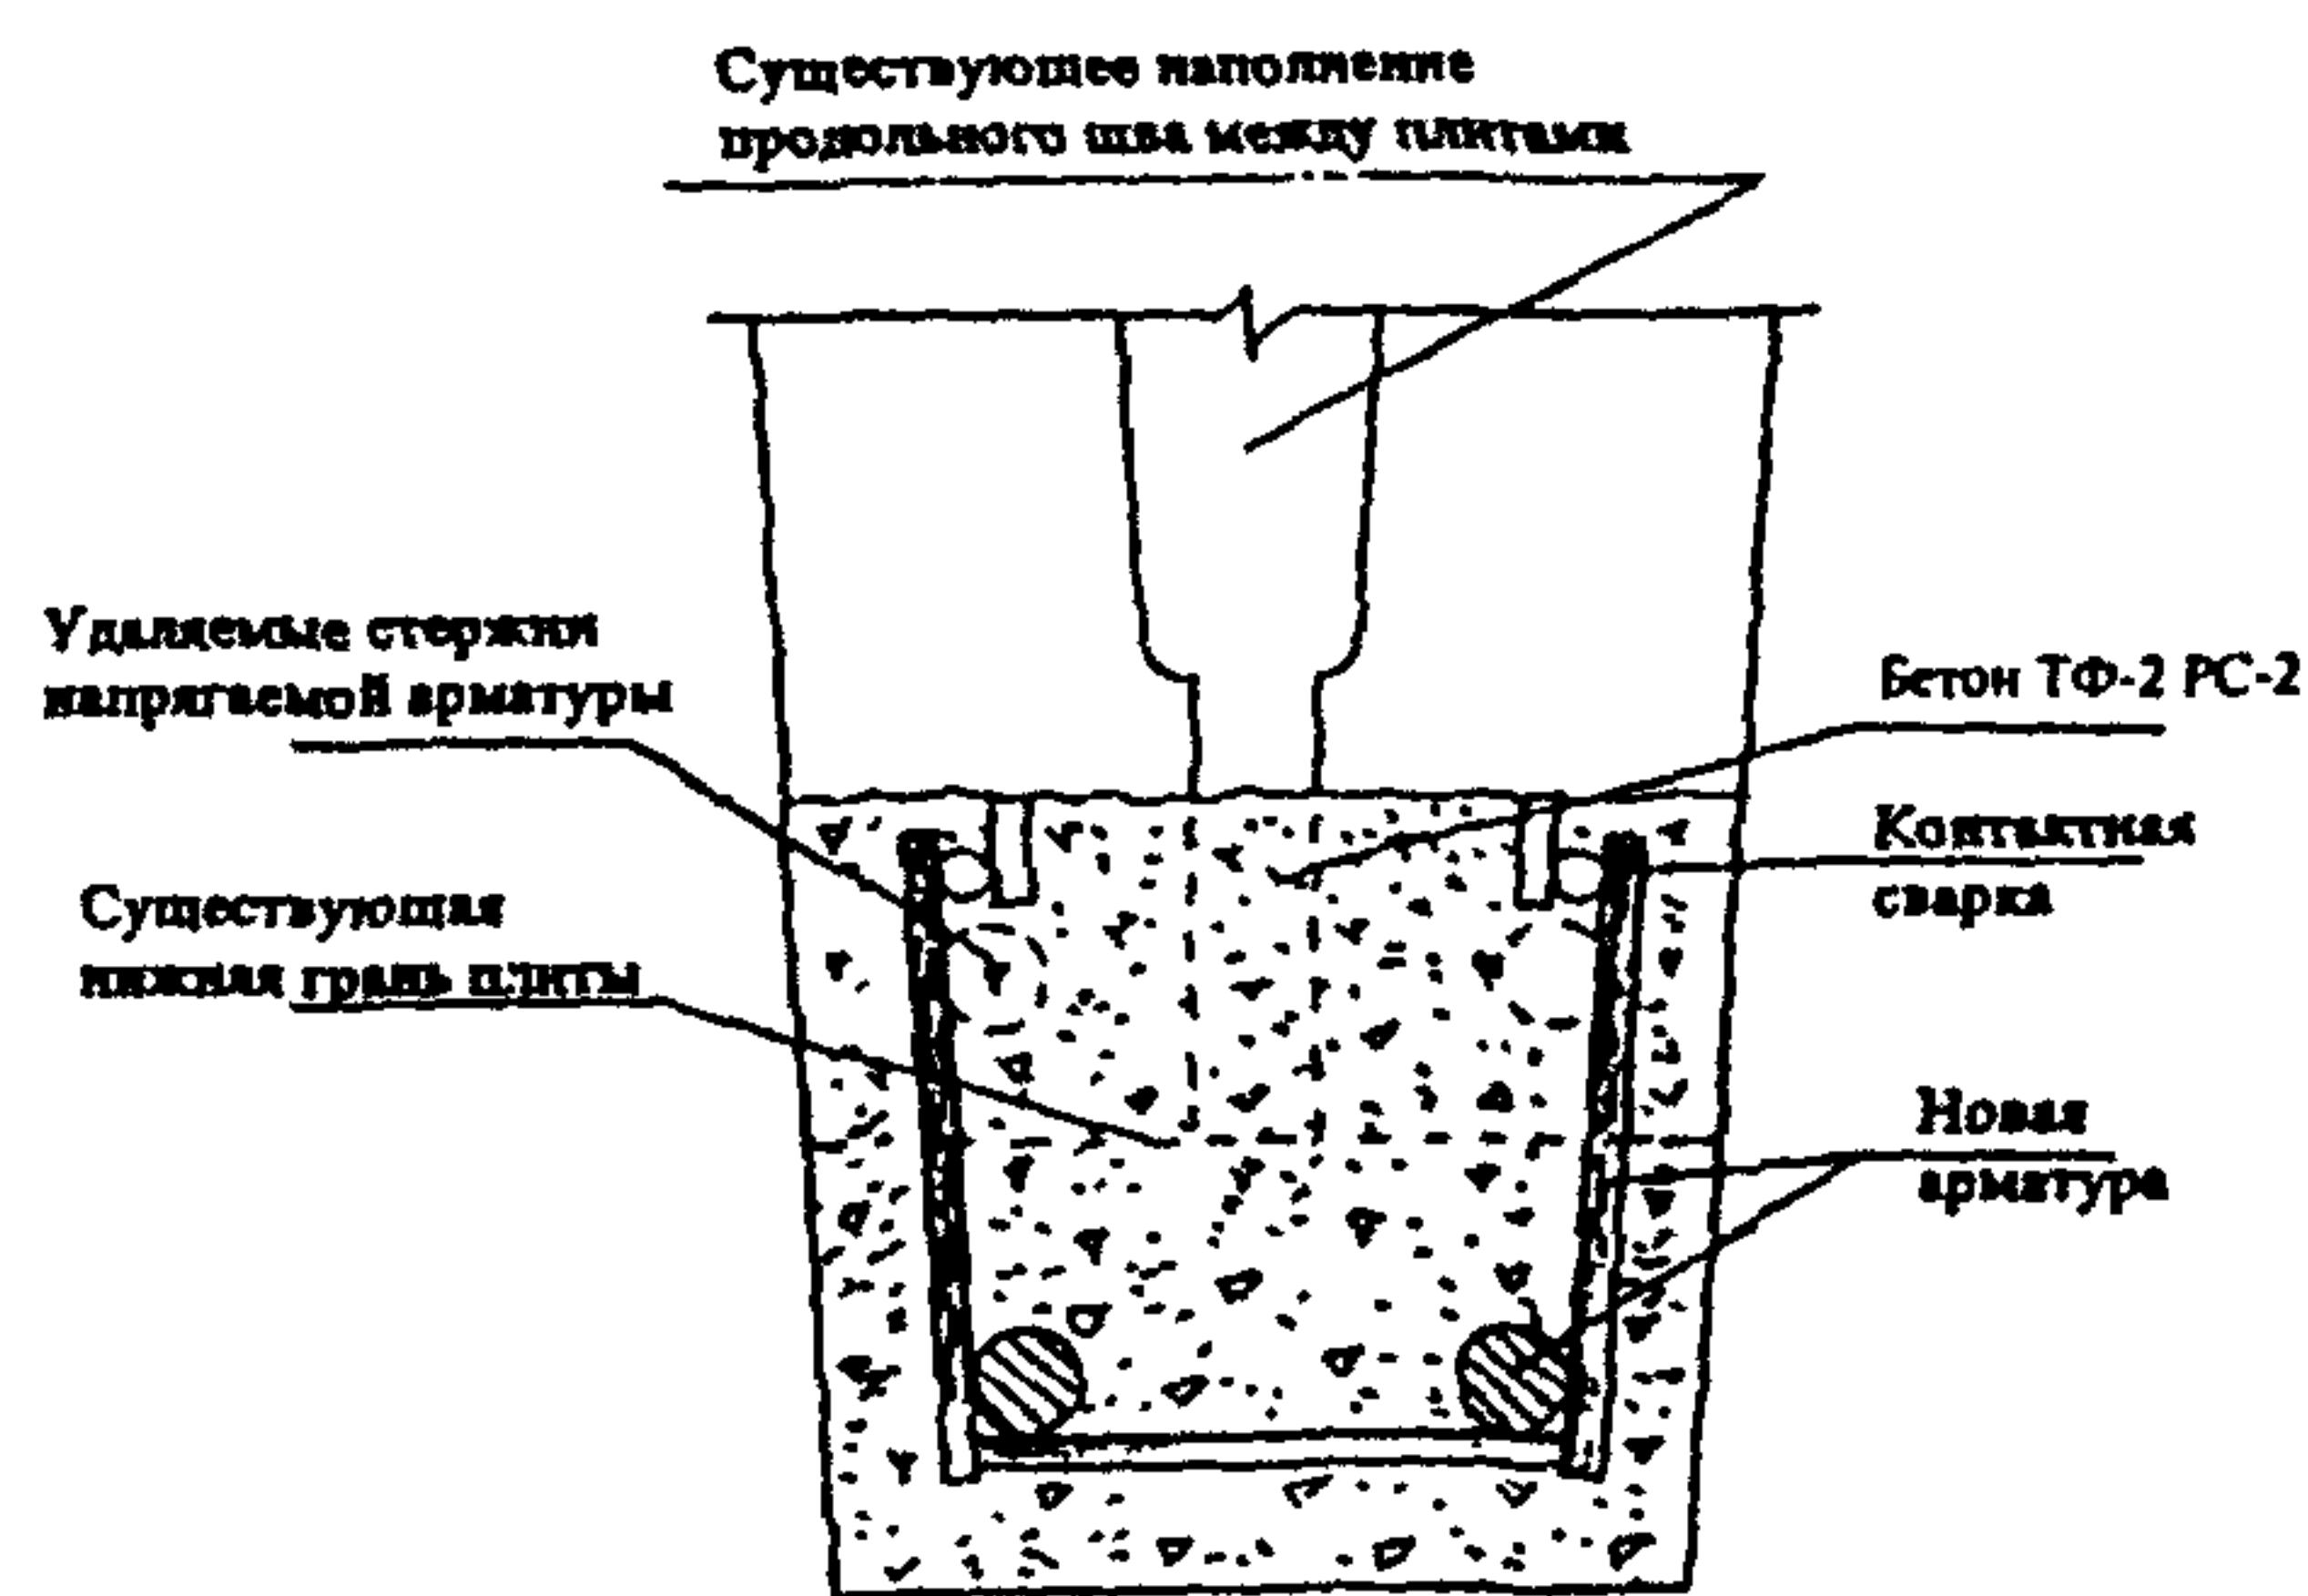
Схема ремонта продольных ребер плит покрытия с ненапрягаемой арматурой, если они опираются на один и те же балки (расчеты уточняются проектом)
